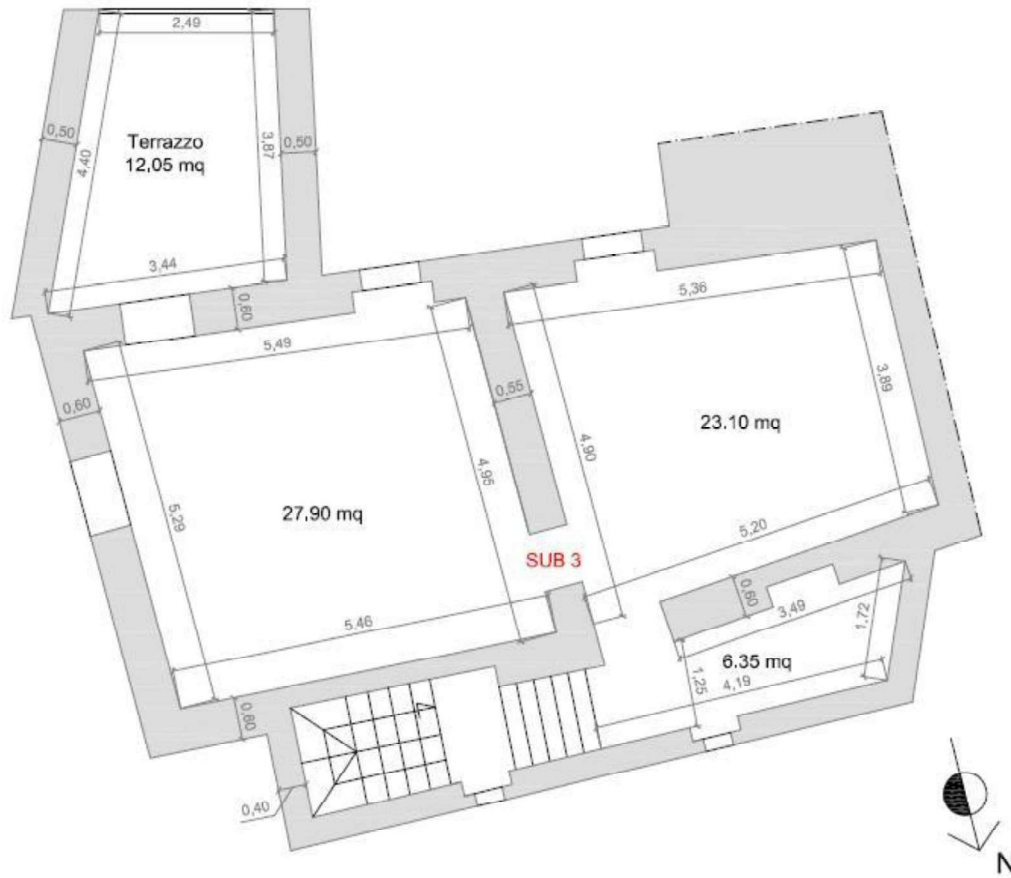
Planimetria Catastale Immobile, Piano 2, Foglio 35, p.lla 817, Sub 3.
